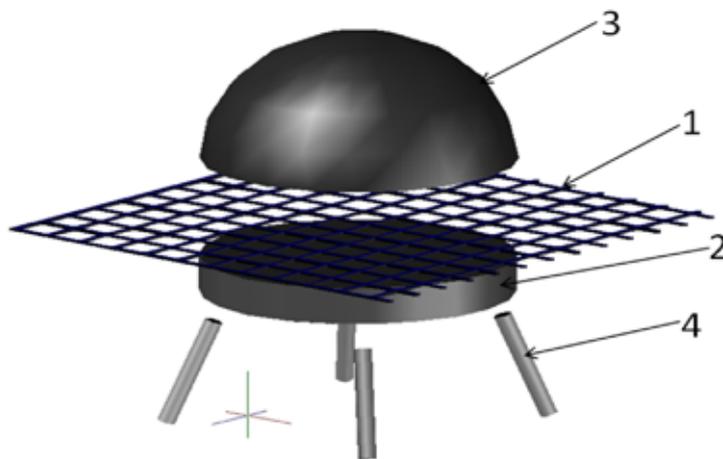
Бетонный блок гибкого бетонного защитного покрытия:
